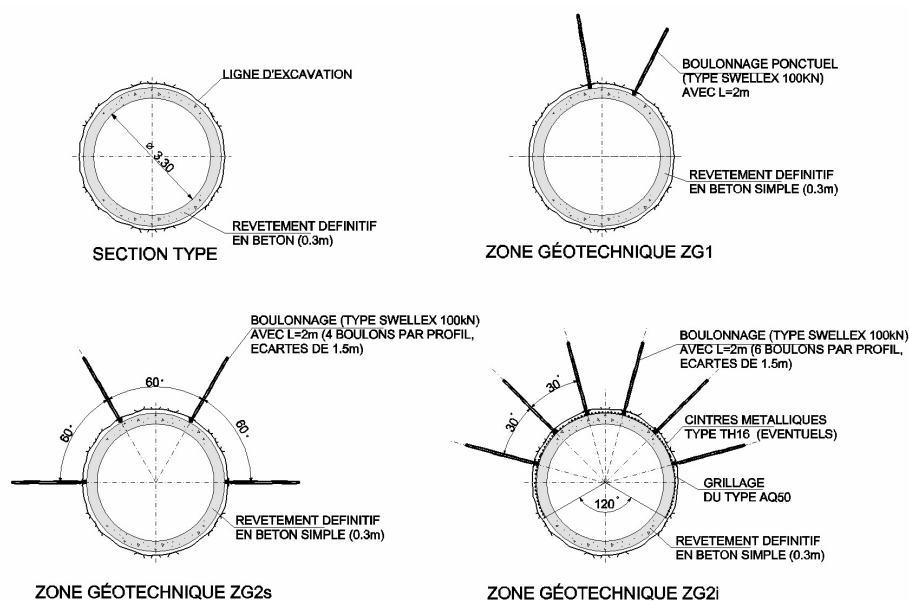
Secção transversal da galeria de adução (construção por tuneladora)
